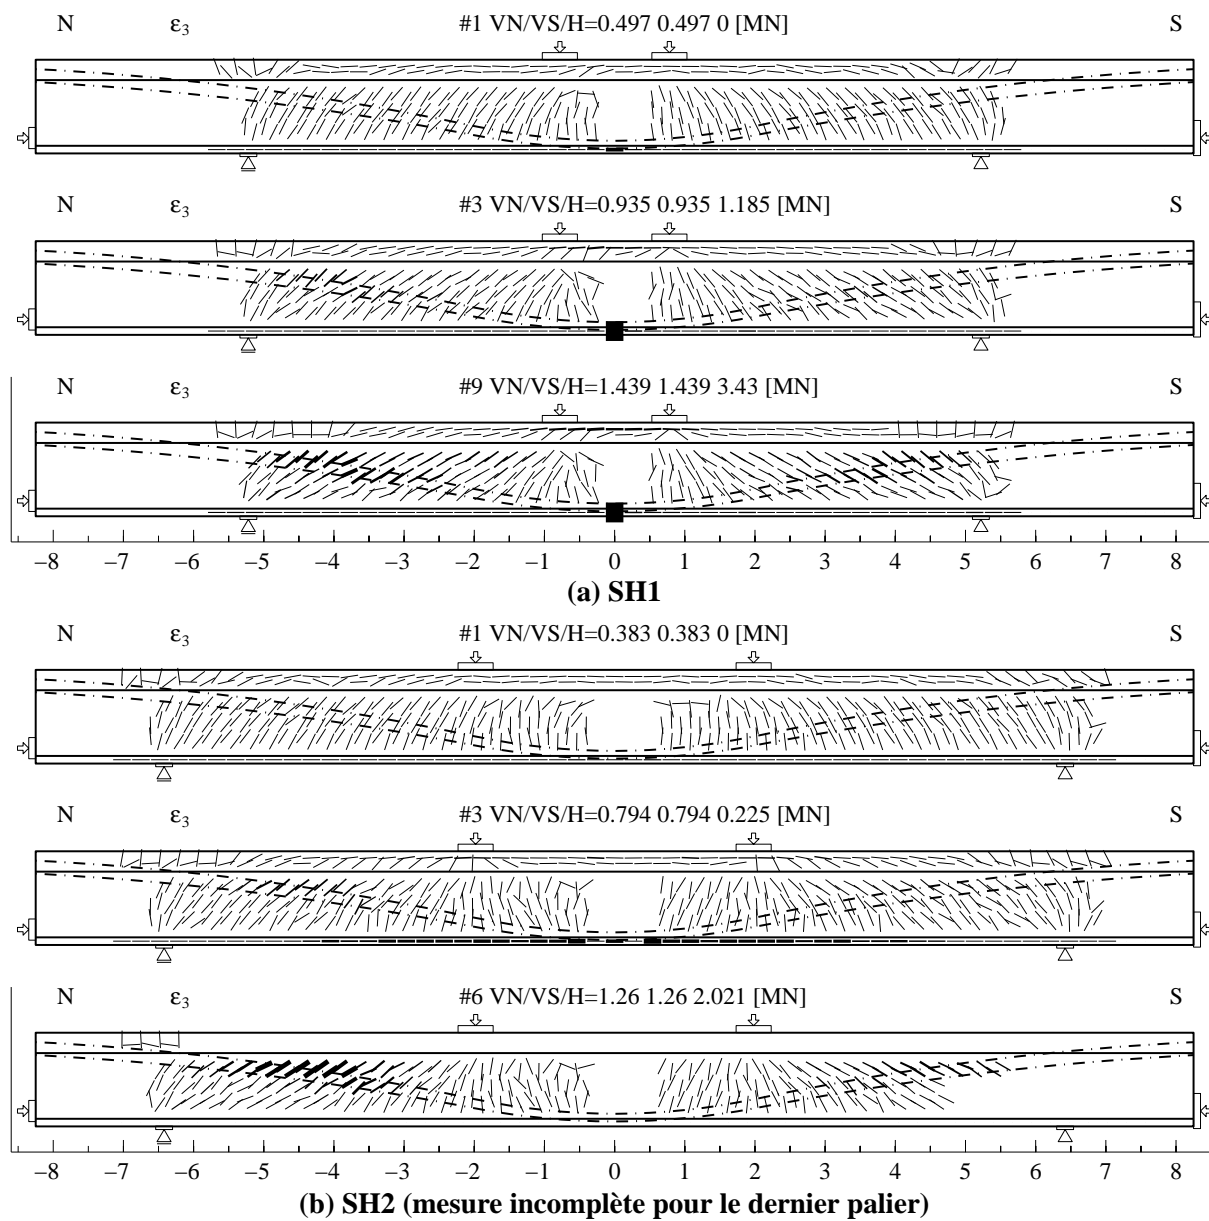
Essais SH1 et SH2 : orientation et intensité de la déformation principale ε_3 (aile inférieure : ε_x) du béton pour le premier palier, le palier avec fissuration flexionnelle stabilisée et le dernier palier (longueur de mesure : 270 mm)
